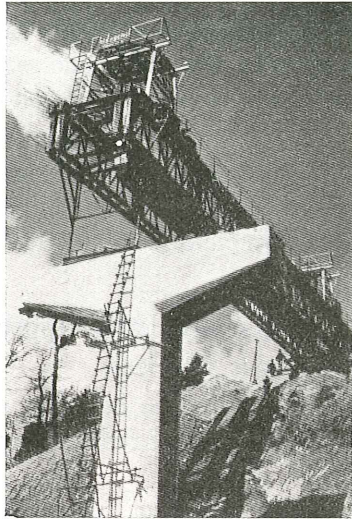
Puesto de lanzamiento, de 60 m de longitud, para vigas de hormigón pretensado. Está formado por cuatro elementos en celosía, constituidos por piezas de 6 m de longitud que se unen mediante un pretensado. Las armaduras de pretensado están formadas por alambres de 7 mm de diámetro anclados en grupos de cuatro. El procedimiento de pretensado utilizado ha sido el P.S.C. El momento máximo que puede resistir este puente es de 900 m t.
